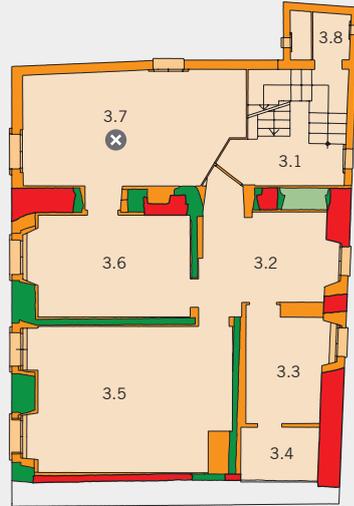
Zug, Dorfstrasse 11, Grundriss des dritten Vollgeschosses.
